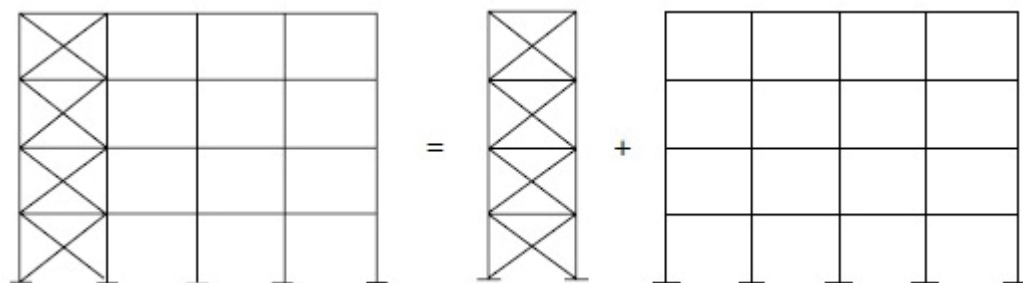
Divisão do pórtico com ligações rígidas em duas subestruturas [30].
